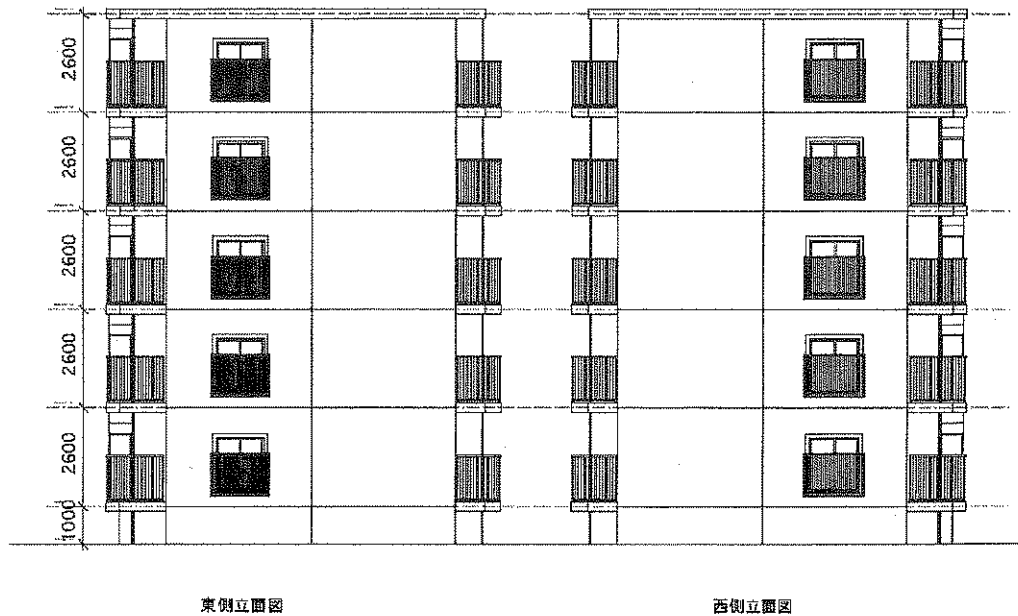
都心型モデルの既存建物立面図(縮尺:1/200)
